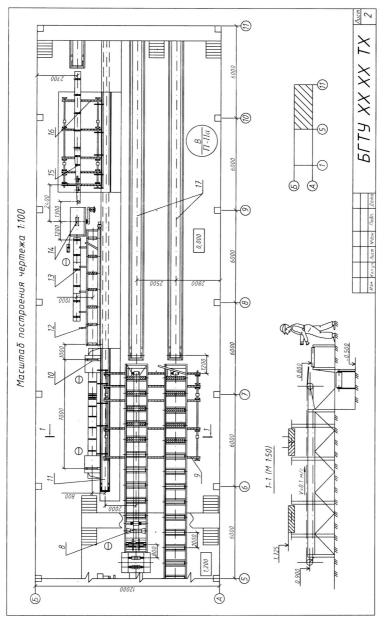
Схема одноэтажного песопильного цеха (участок переработки досок)
